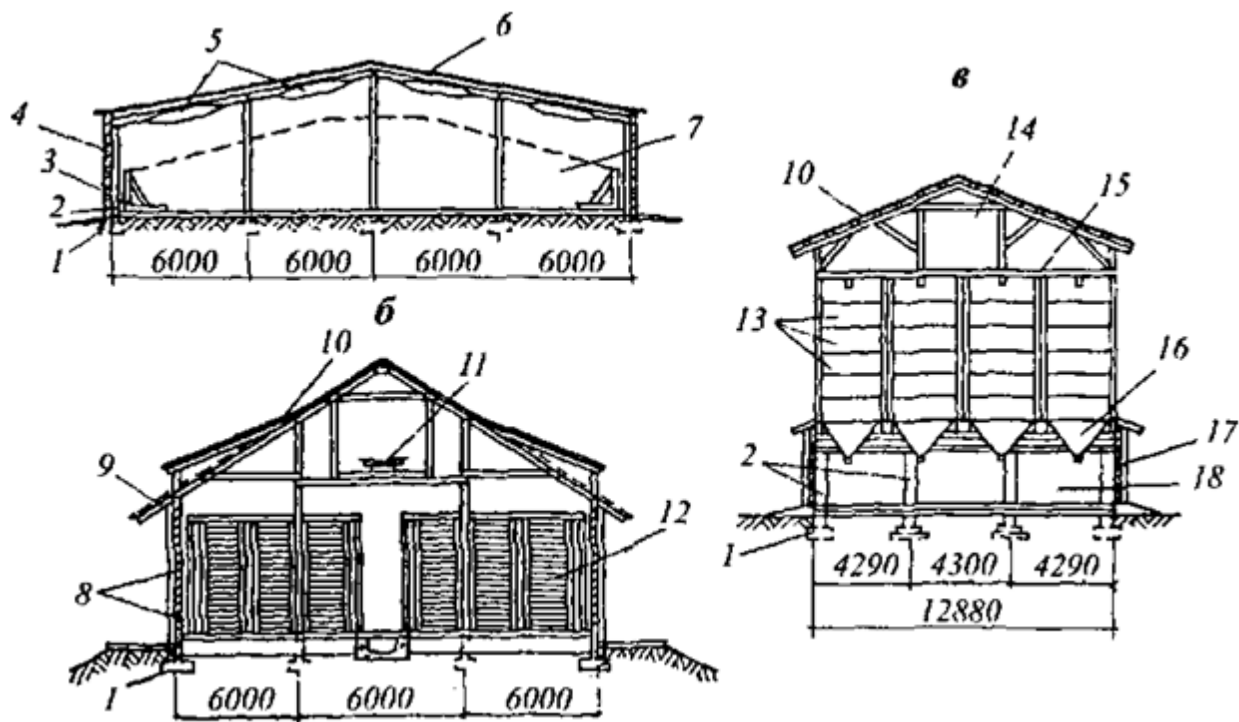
Поперечные разрезы зернохранилищ: а — напольных; б — закомных; в — бункерных; 1 — фундамент; 2 — колонна; 3 — подпорные инвентарные щиты; 4 — стенная панель; 5 — прогоны покрытия; 6 — плиты покрытия с кровлей; 7 — борт зерна; 8 — наружная несущая стена; 9 — стропила; 10 — покрытие из асбестоцементных листов; 11 — верхняя транспортерная галерея; 12 — заком для зерна; 13 — кольцевые элементы бункера; 14 — надбункерная галерея; 15 — деревянный настил; 16 — металлические воронки; 17 — стены из асбестоцементных листов; 18 — надбункерное помещение
